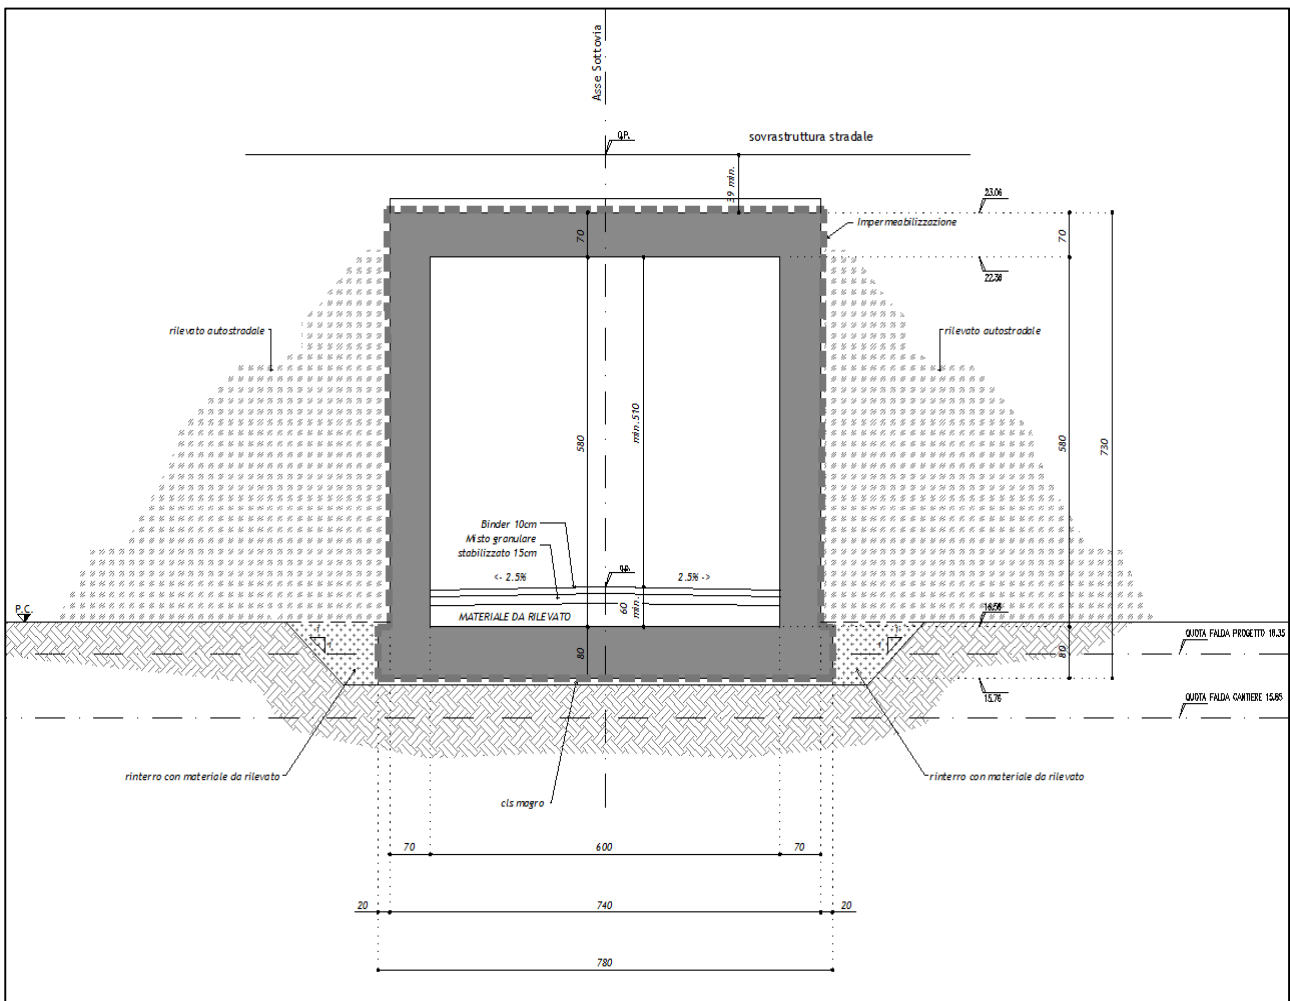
SEZIONE TRASVERSALE DEL SOTTOVIA
